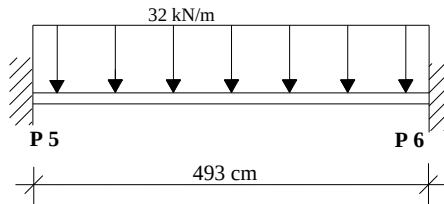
Esquema estático e carregamento no vão da viga adjacente ao pilar P6.
